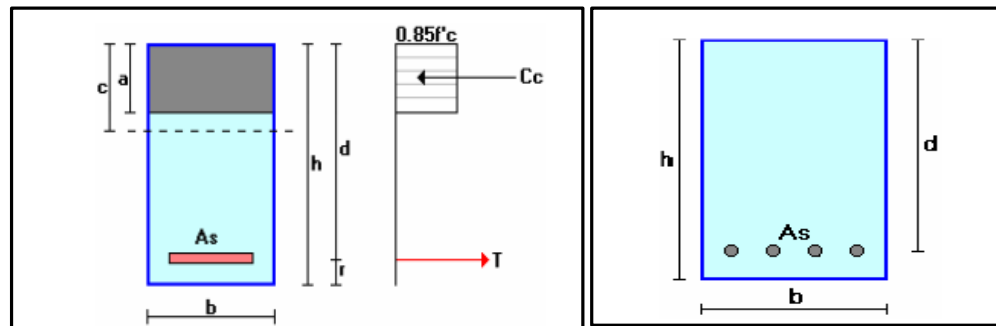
Sección transversal de un elemento rectangular de Hormigón Armado:
